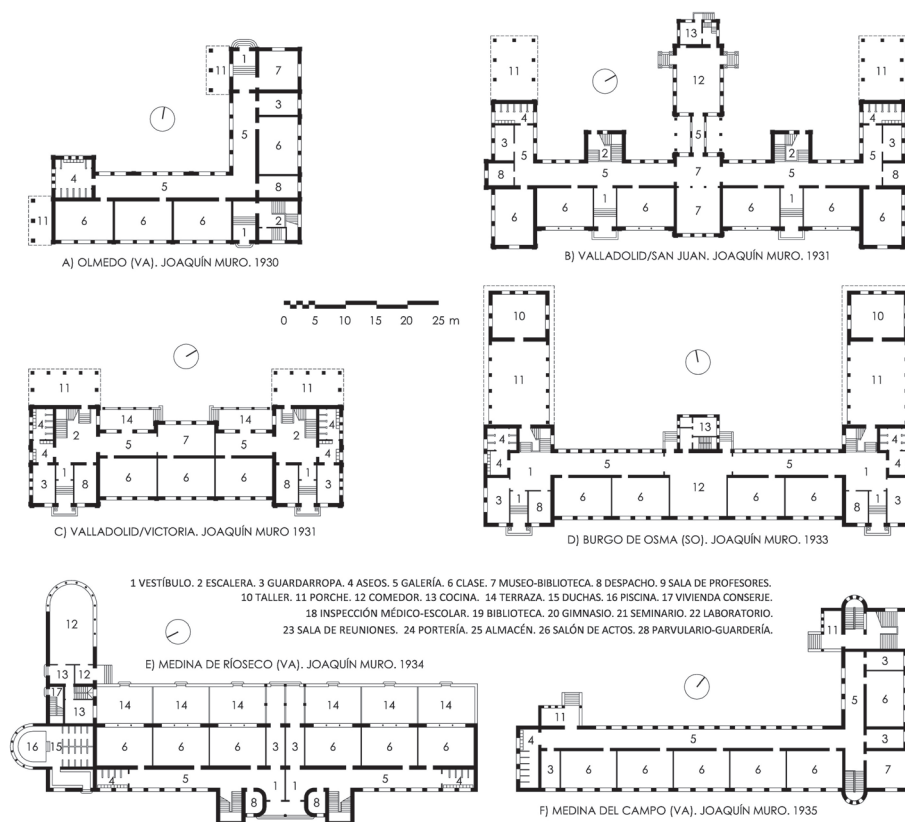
Esquemas de planta de otras escuelas graduadas proyectadas por Joaquín Muro Antón (Fuente: Javier Rodríguez Méndez).
